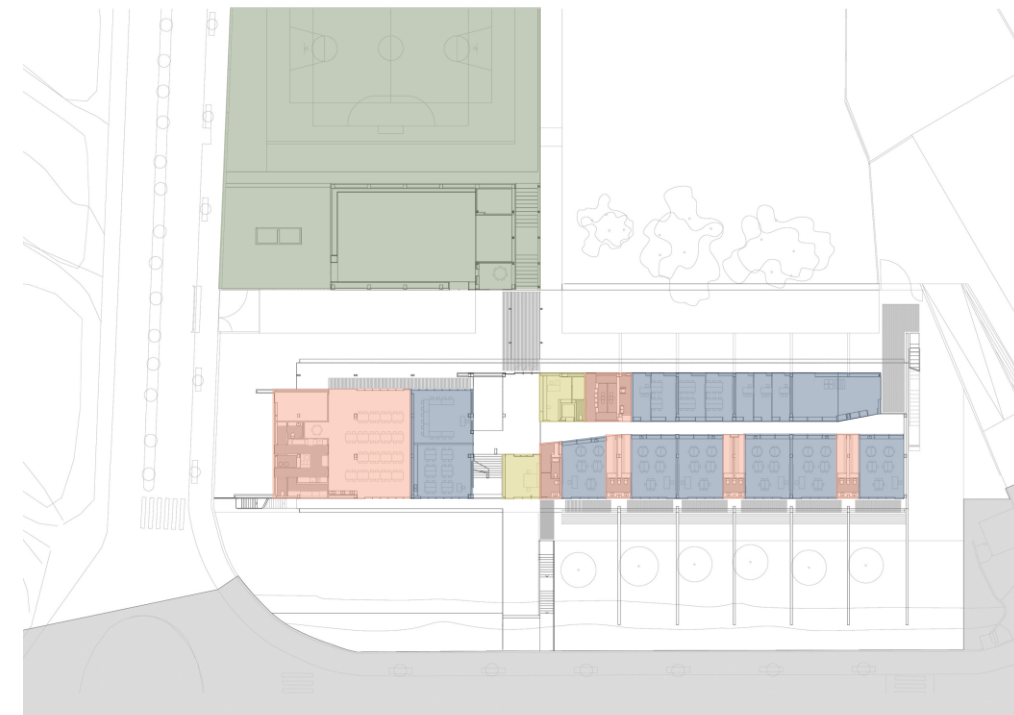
Planta baixa pavimento inferior - Fonte: Baas Arquitectura, 2017
